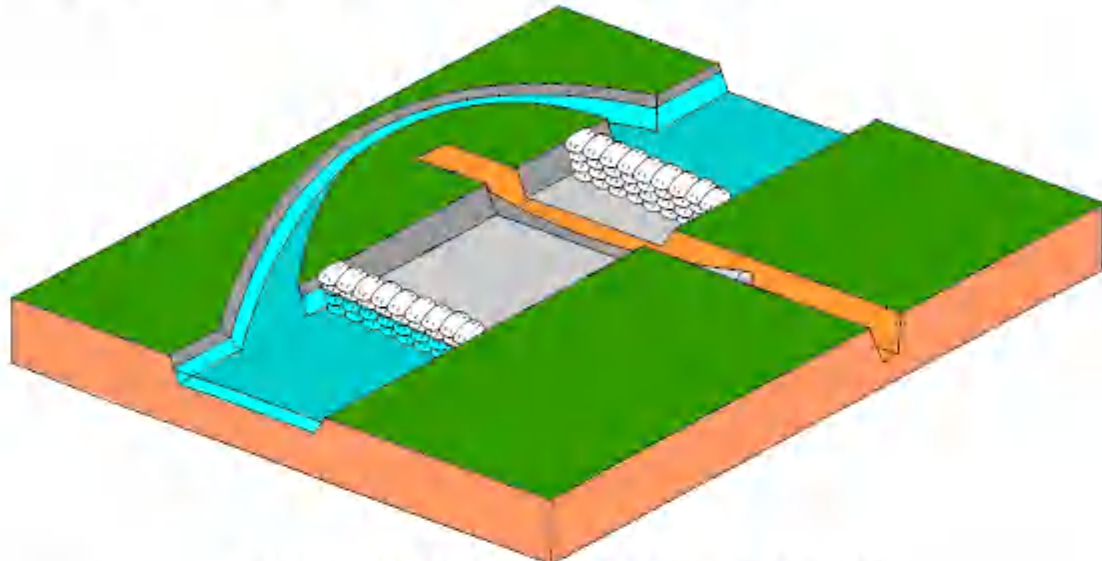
围堰导流开挖管沟法施工断面示意图
